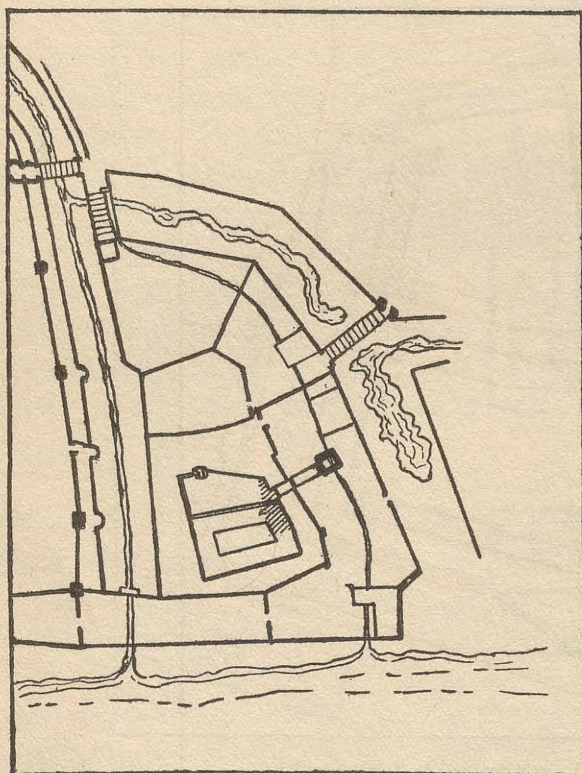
Burg Thorn. Lageplan nach Steinbrecht.
